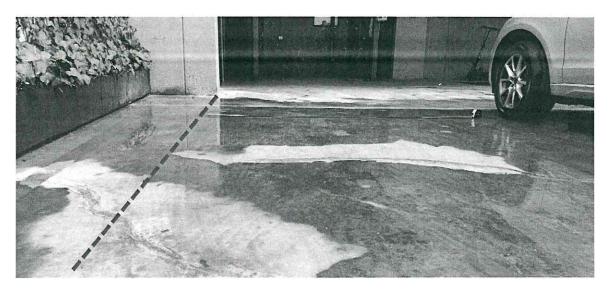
Ancho de parqueadero 48 - 2.43m al eje de la demarcación
